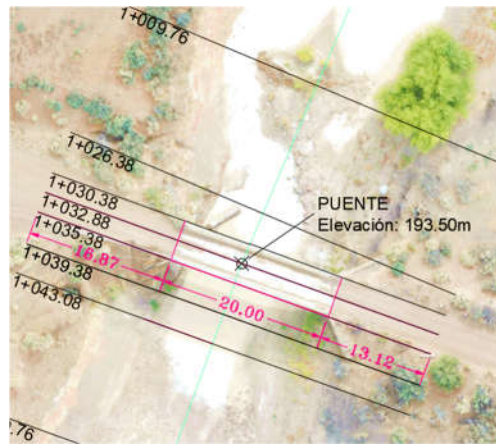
Vista en planta del puente (Autodesk Civil 3D)
